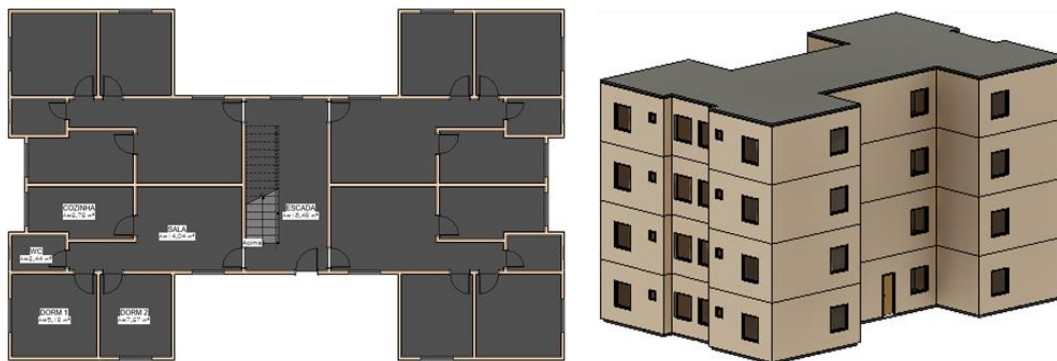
Planta baixa (esquerda) e vista 3D (direita) da edificação base.
